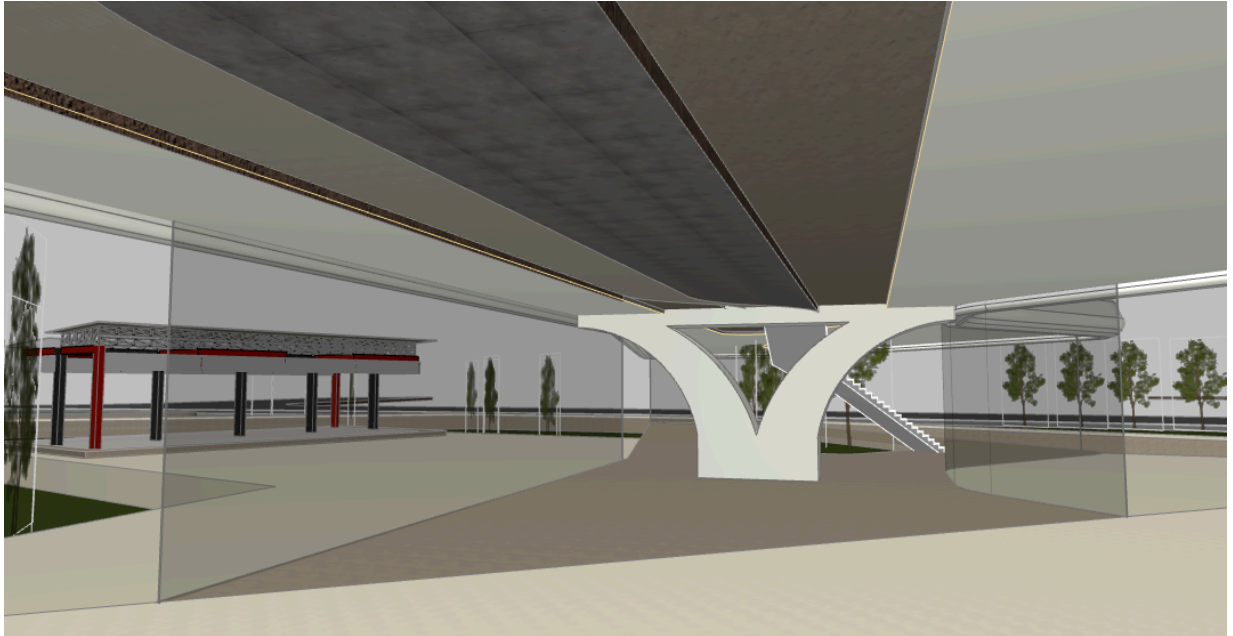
Rancangan Perubahan Visual Fasad Bangunan Eksisting
